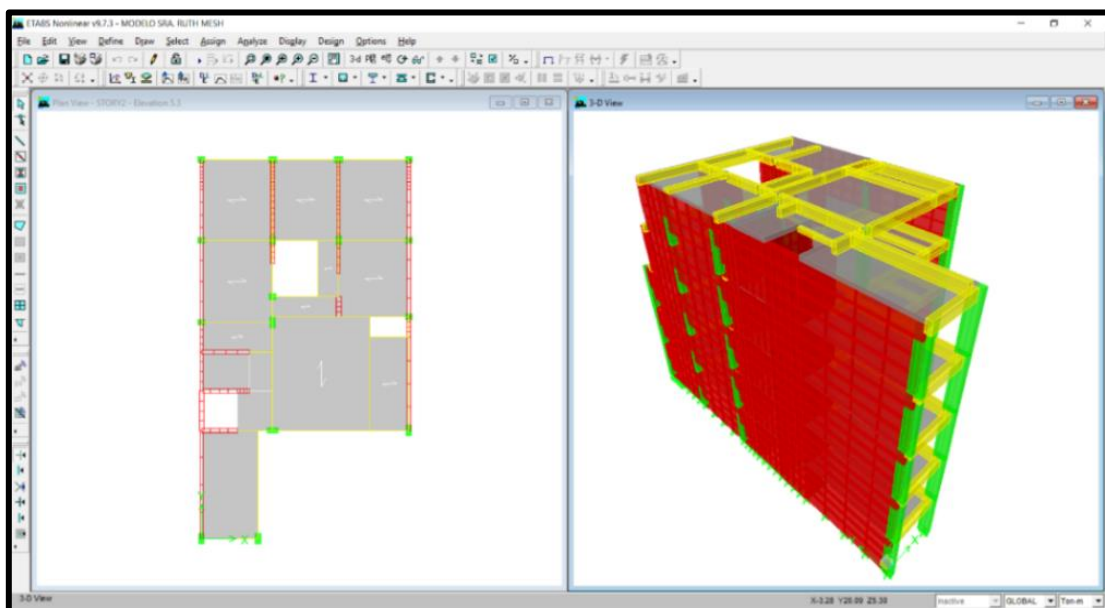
Modelo Estructural con el sistema de losa con viguetas pretensadas de los 5 pisos de la edificación en evaluación estructural
